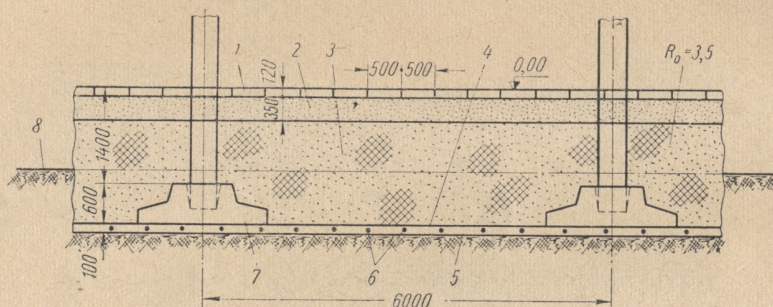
Конструкция пола холодильника при подогреве грунта электротоком:
